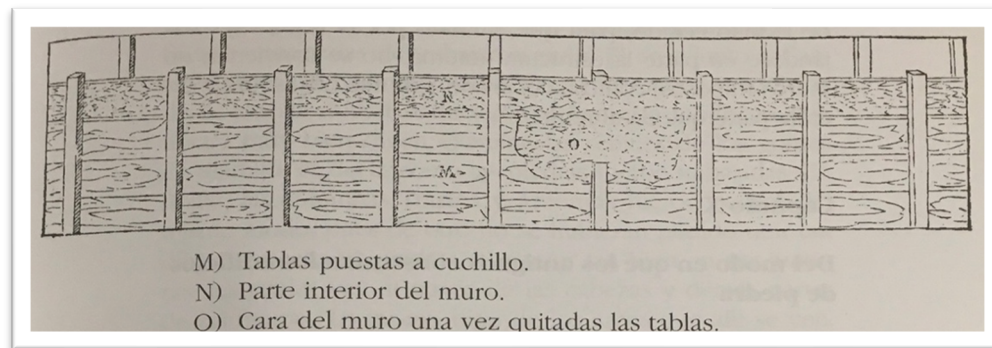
Sistema constructivo para muros de mampostería a la manera de henchidura. Imagen tomada de: *Andrea Palladio. Los cuatro libros de la arquitectura*, España, Ediciones Akal. 1a. Edición Rústica, 2015, p. 67.
